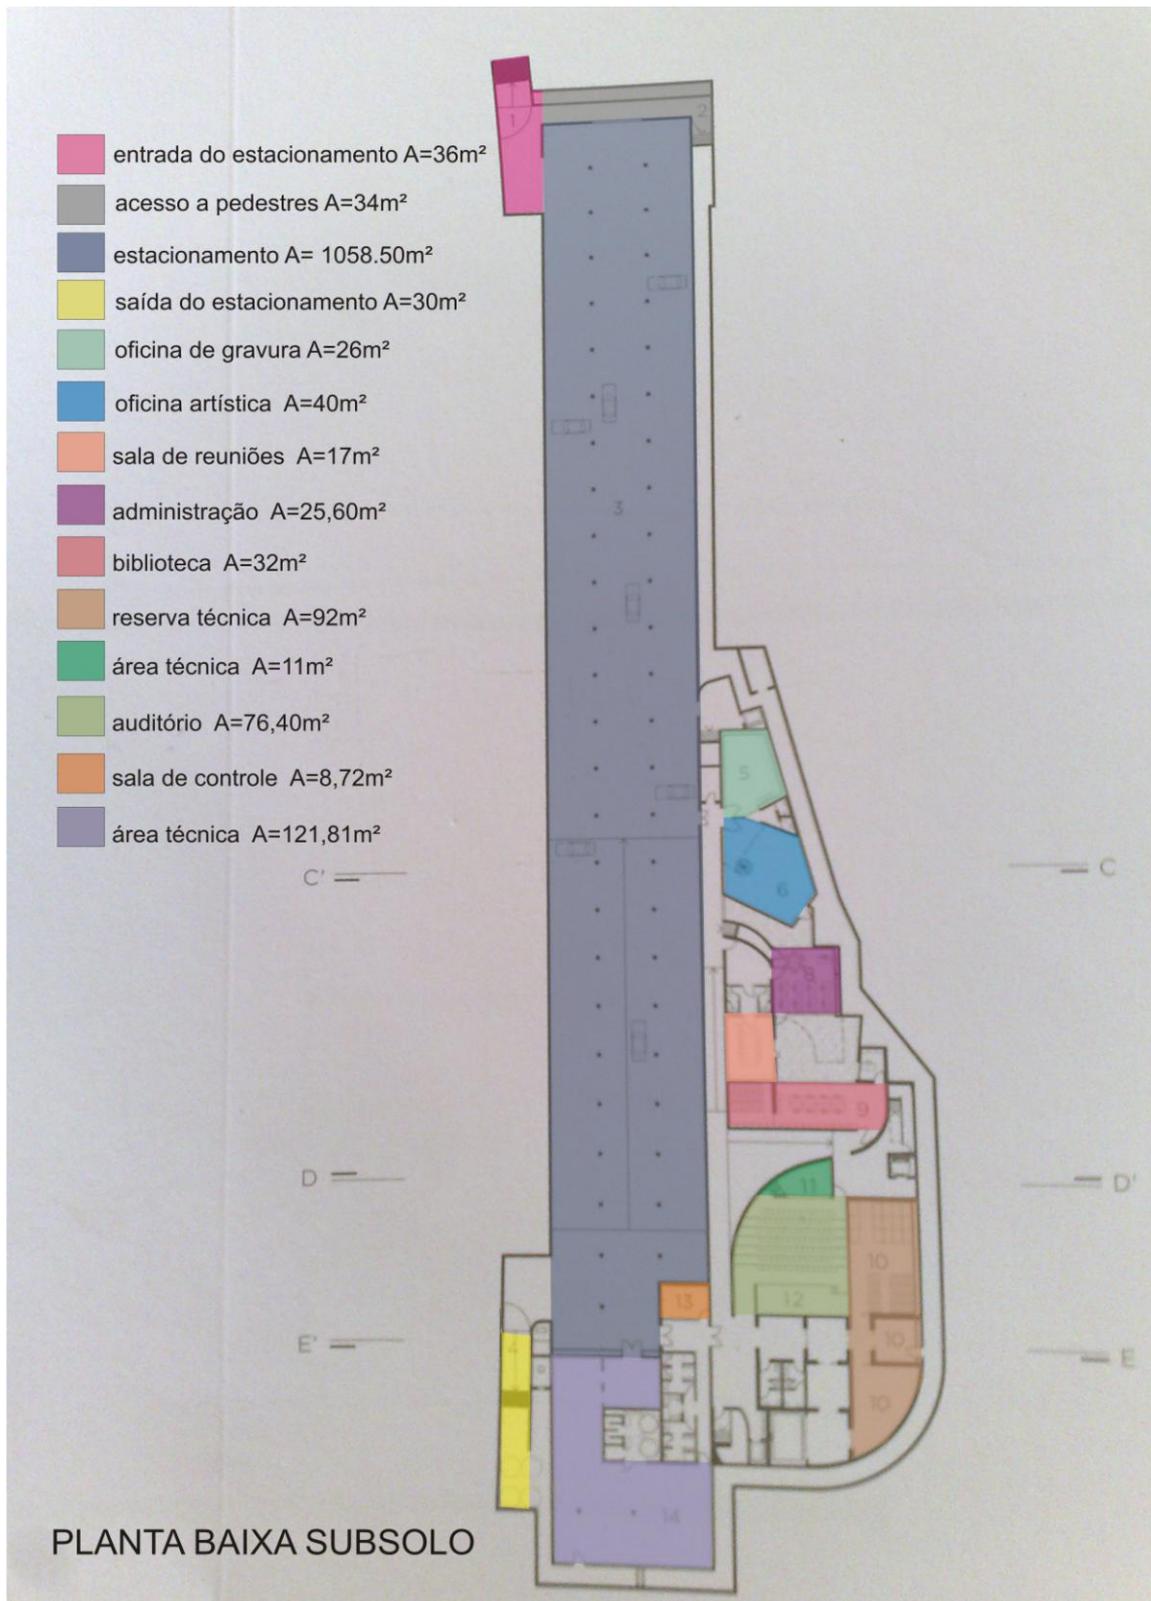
Planta Baixa Subsolo (KIEFER, 2008)
